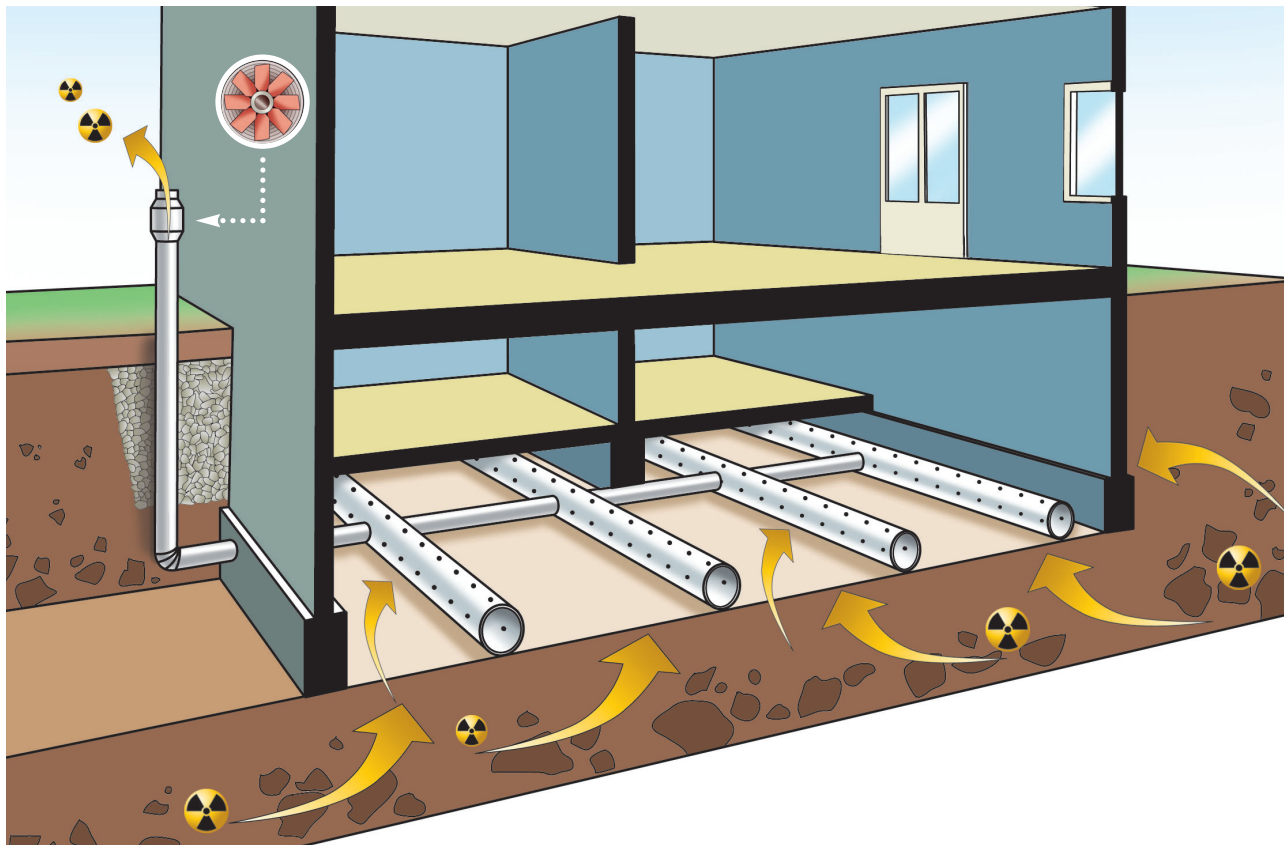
Sistema di drenaggio realizzato sotto un'abitazione con fondazioni a strisce.
